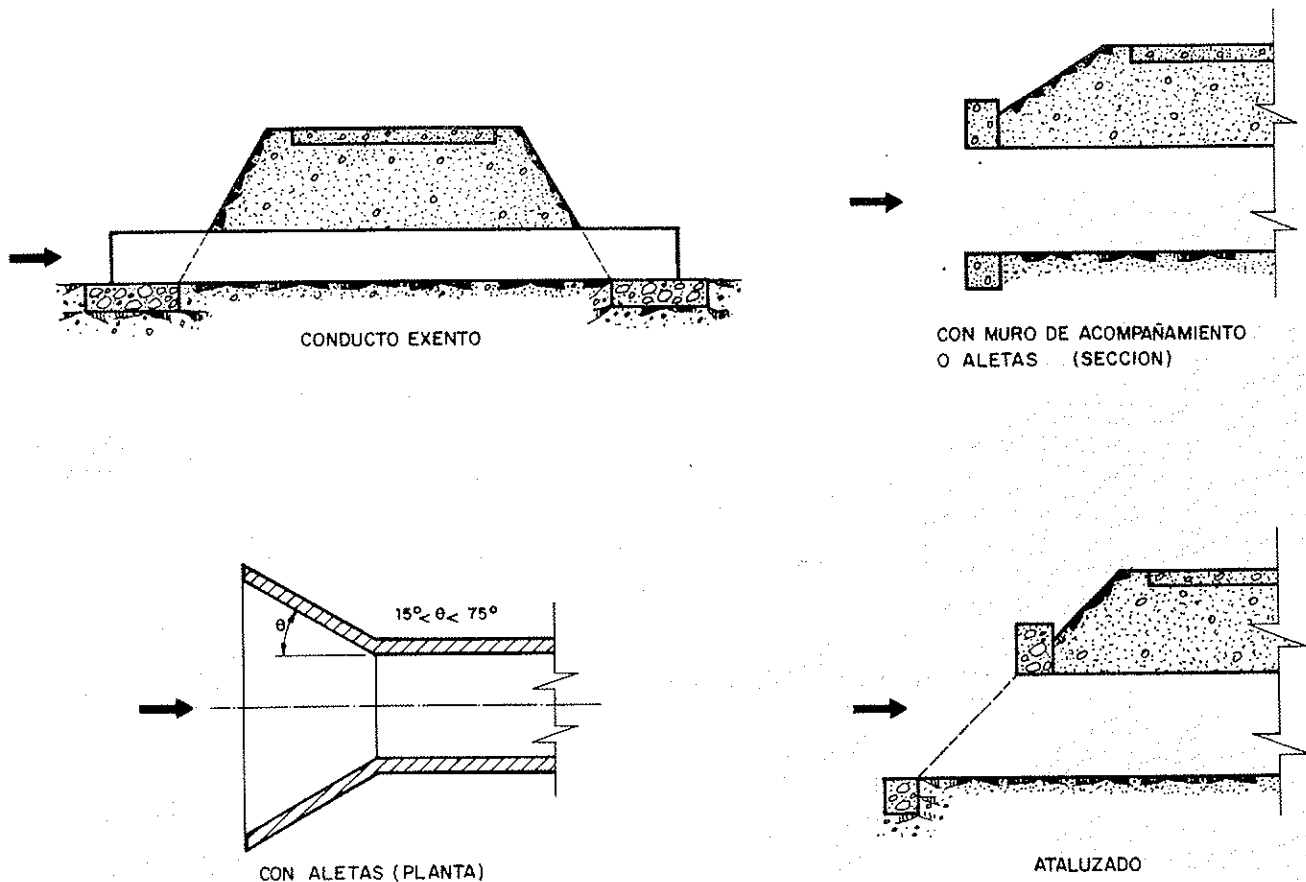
TIPOS DE EMBOCADURAS BAJO TERRAPLEN
